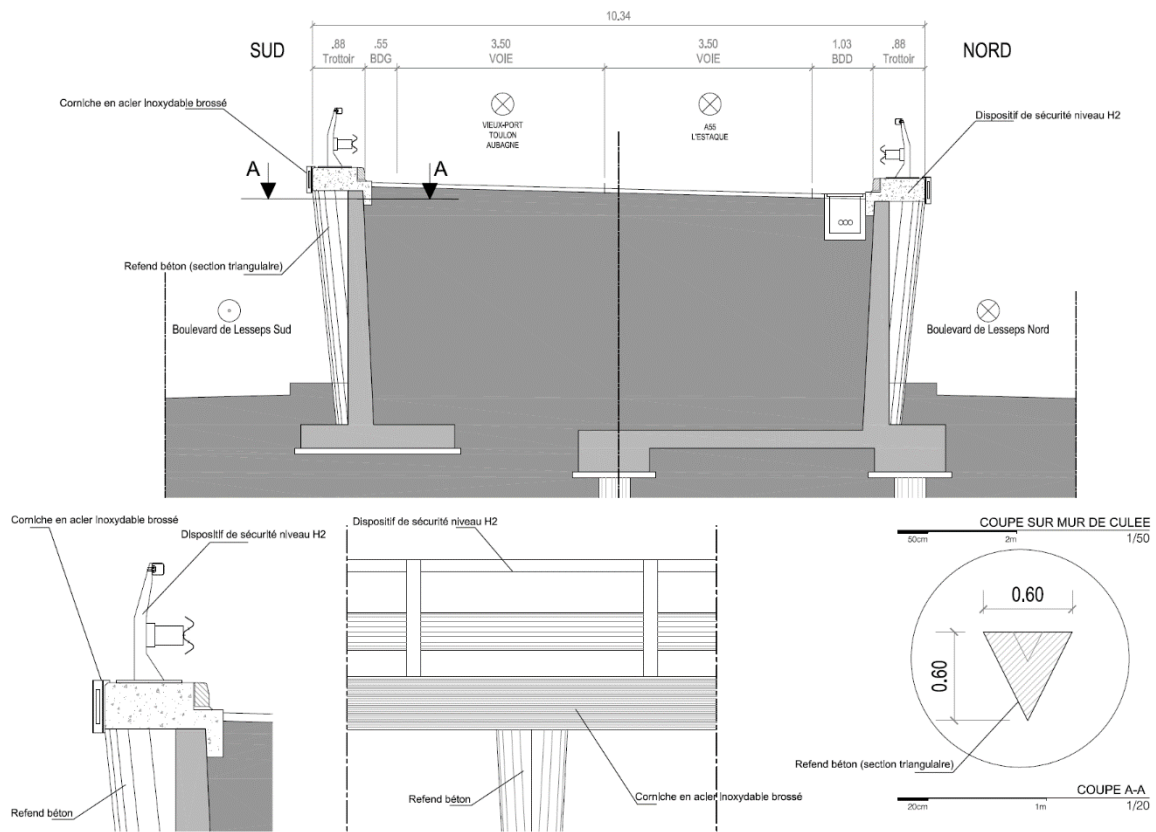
Coupe sur la rampe d'accès à l'ouvrage
